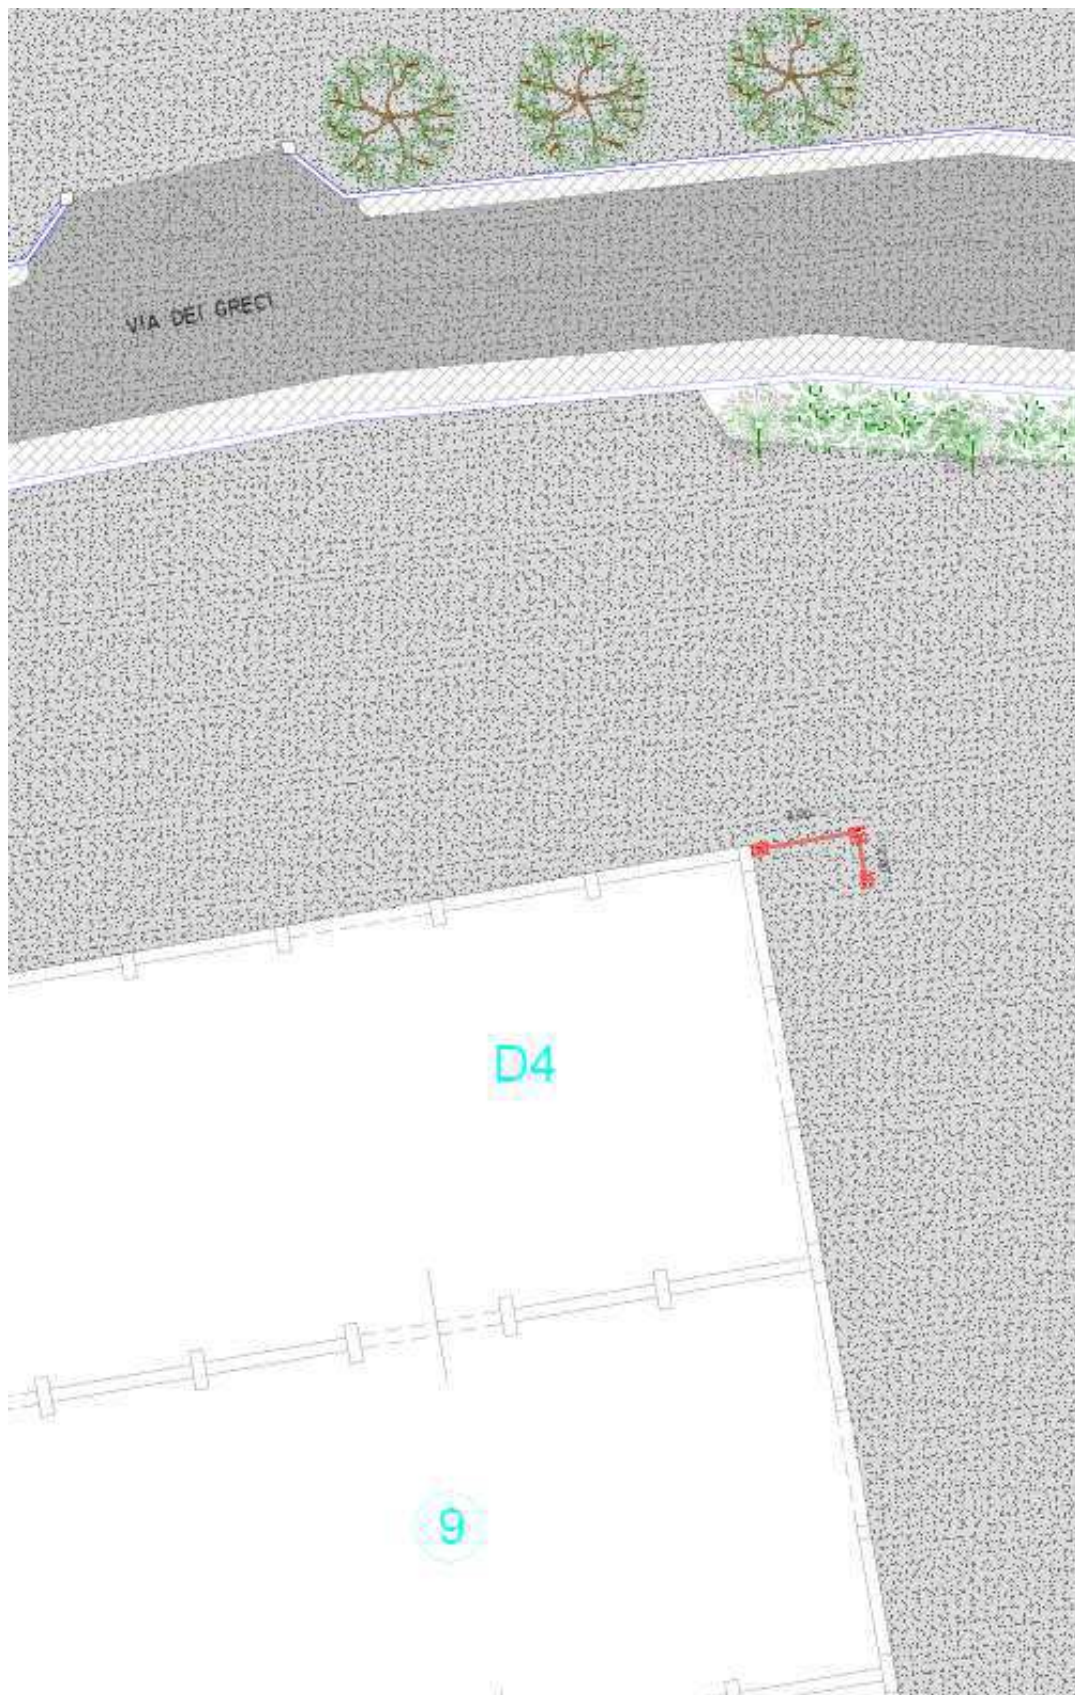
Individuazione planimetrica barriera di contenimento acustico C
